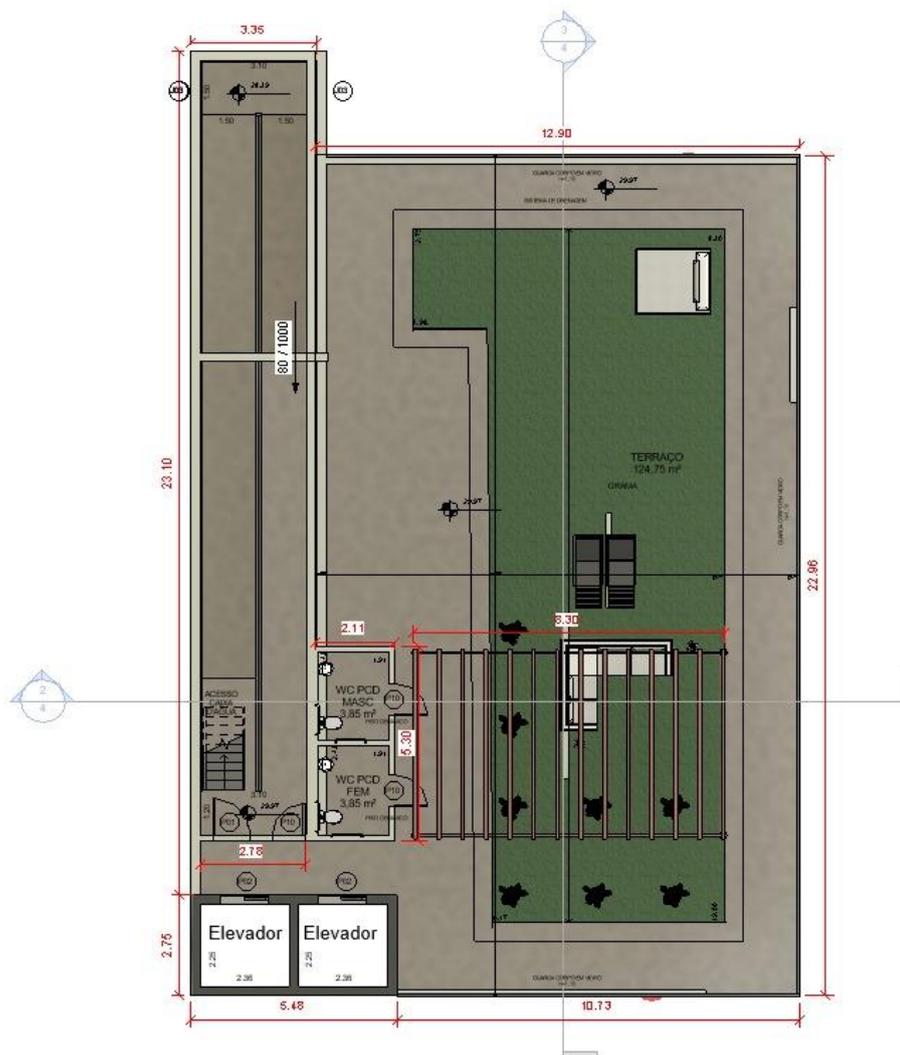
Planta Baixa Pavimento Tipo II
